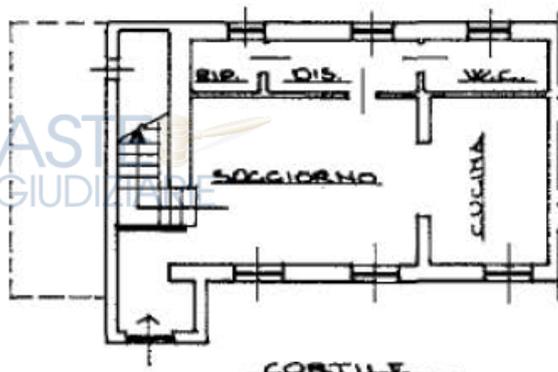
Estratto di planimetria catastale del 07.12.1993 n. T50523
